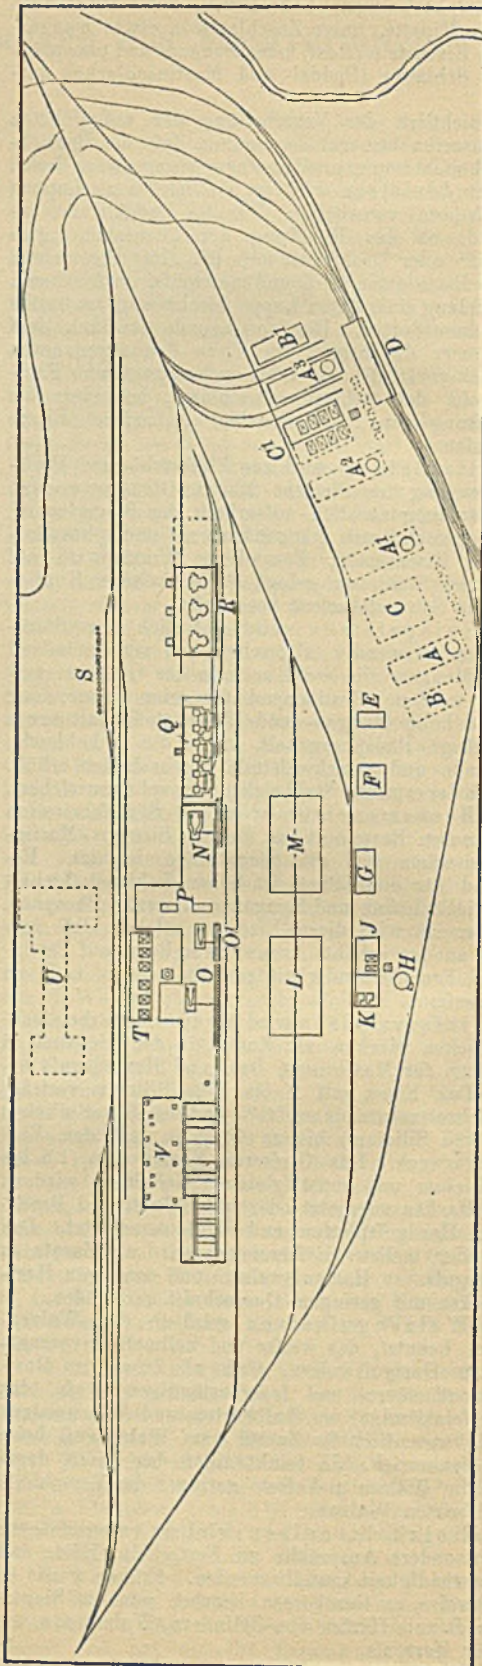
Lageplan der Stahlwerke in Monterrey.
